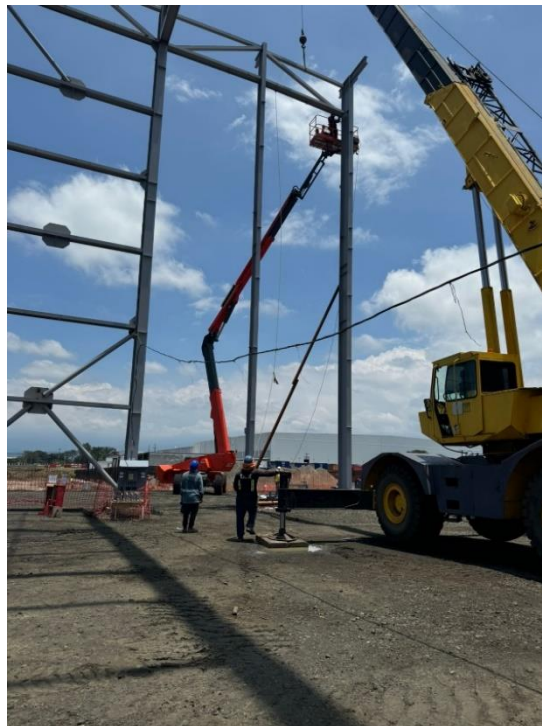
Pedestal de concreto reforzado para apoyo de columna metálica.
